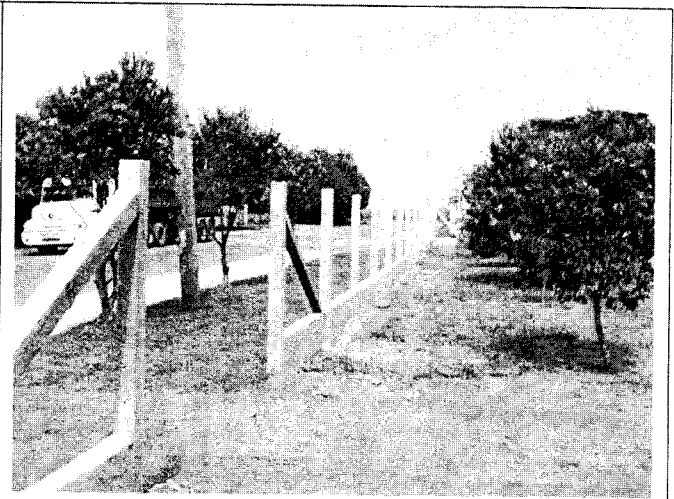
Mureta e alambrado em execução no entorno do terreno da Escola.
